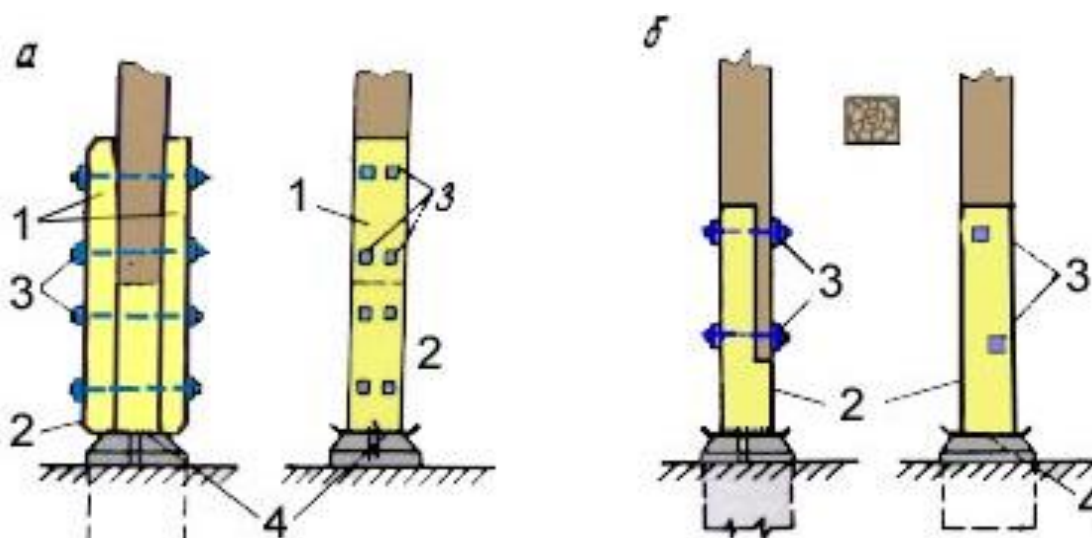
Ремонт стоек прямоугольного сечения: 1 – новые деревянные накладки; 2 – новые концы стоек; 3 – стальные болты; 4 – гидроизоляция
